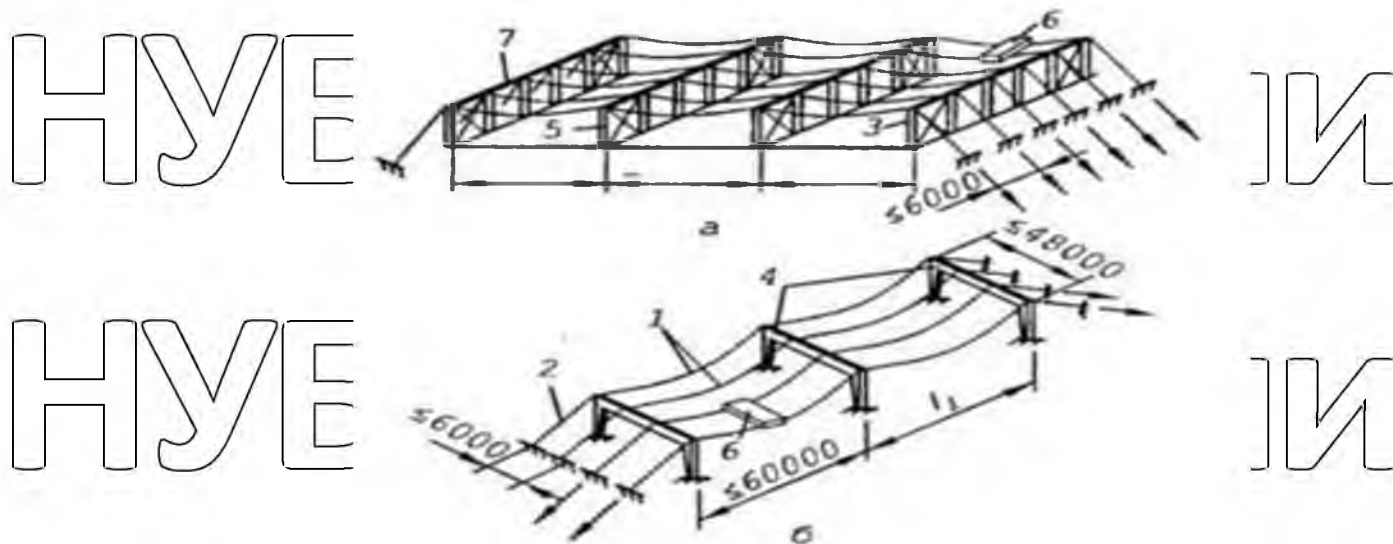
Схема багатопролітних одноповерхових прямокутних покриттів: а - з несучими колонами; б - з несучими рамами; 1 - несучі ванти; 2 - підтяжки; 3 - колони; 4 - рами; 5 - зв'язки; 6 - залізобетонні плити; 7 - балки опорного контуру.
